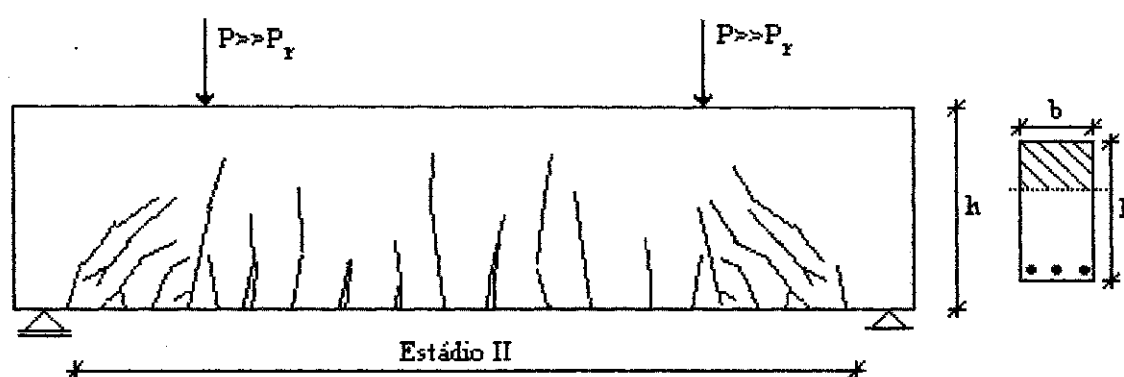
Fissuração Pouco Antes da Ruptura
